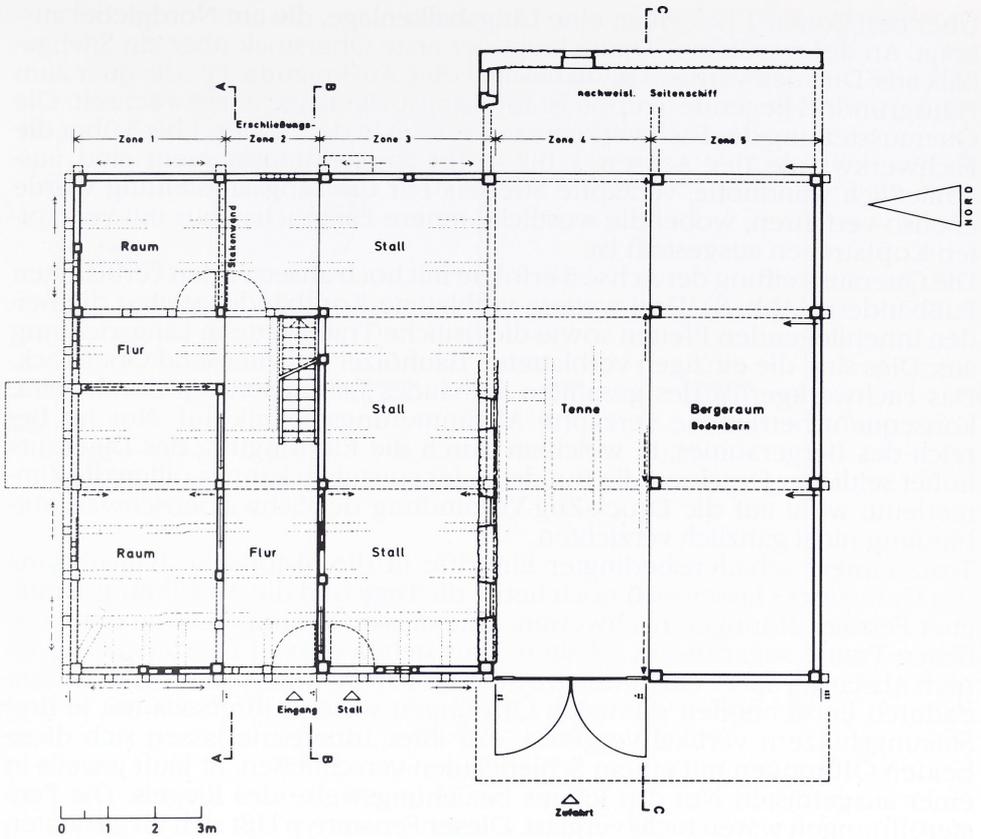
Metzingen, Gustav-Werner-Straße 21, Grundriß Erdgeschoß.
